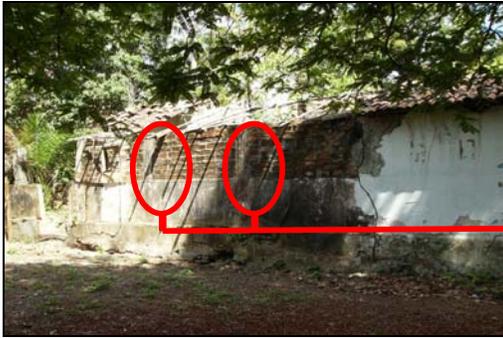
Fachada da casa principal do engenho Jaguaribe atualmente. Notam-se as paredes de alvenaria em tijolos recentes preenchendo as lacunas entre os pilares do alpendre da varanda. Foto: Hermínio.
